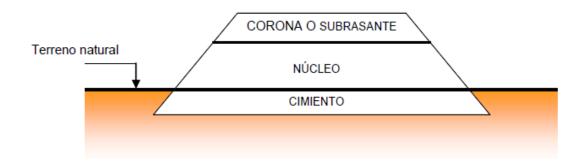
Partes componentes del terraplén en una obra vial. Fuente: (Bowen, 2011).
